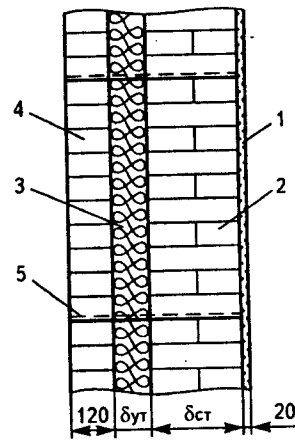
Кирпичная стена с утеплением плитами из минерального или стеклянного волокна: 1 – внутренняя штукатурка; 2 – несущая кирпичная стена; 3 – плиты теплоизоляционные; 4 – облицовка из лицевого кирпича; 5 – гибкие связи
